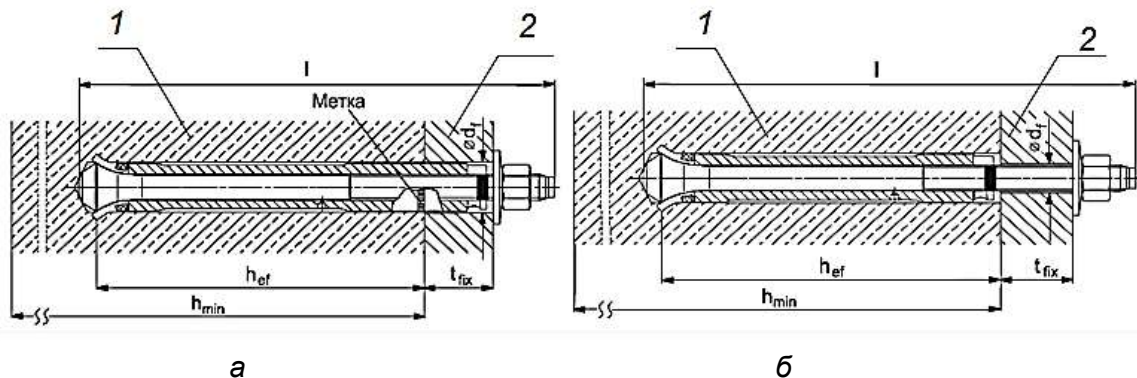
Схема кріплення виробів на поверхні конструкції:
